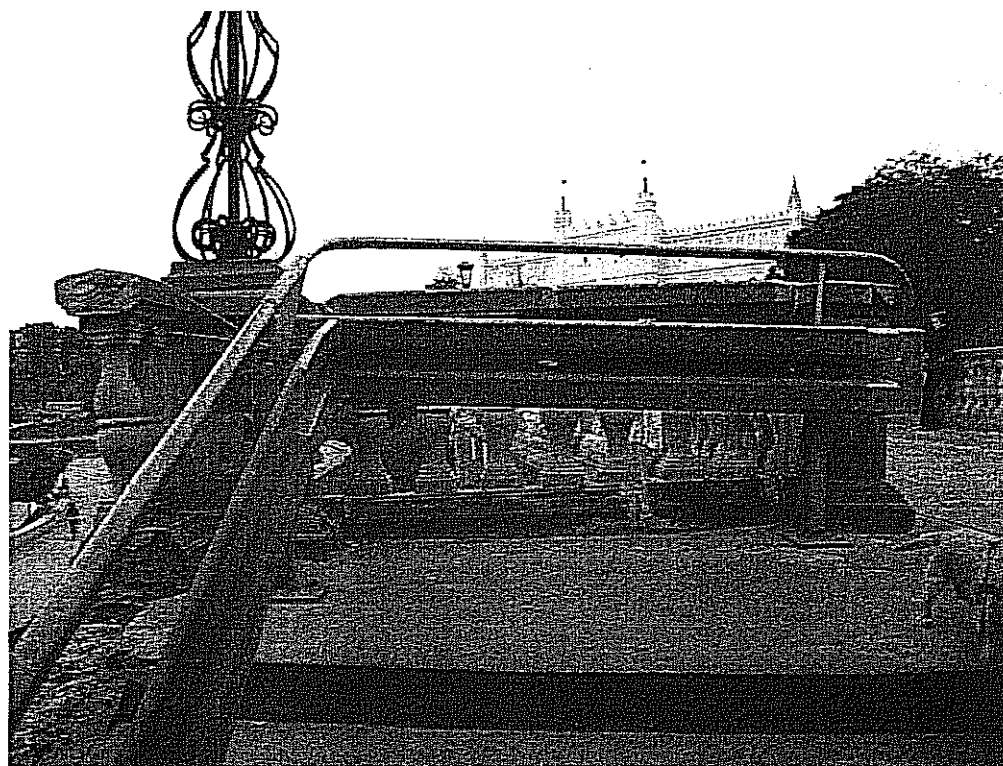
Braki płyt licowych z kamienia, częściowe całkowite zniszczenie i degradacja balustrady. Odrywanie się płyt licowych wraz z betonową płytą, z którą są przytwierdzone do muru z cegły.
